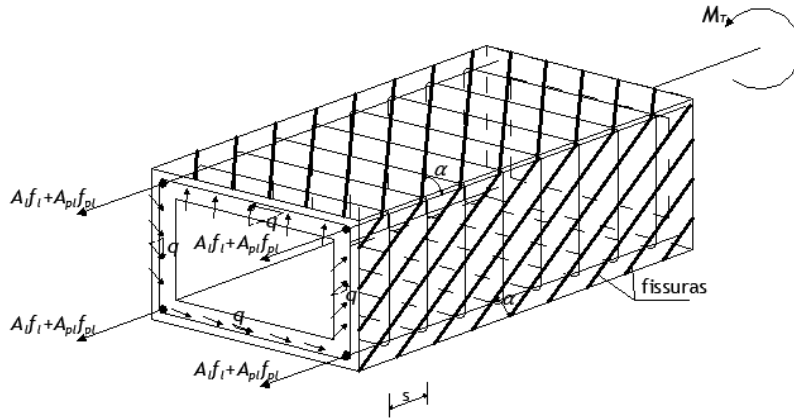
Viga de betão pré-esforçado com seção vazada sujeita a um momento torsor
